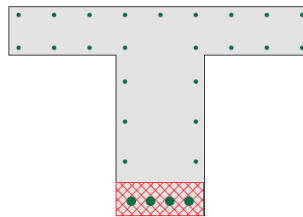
Zone entourant l'armature principale d'une section en T pouvant être considérée comme tirant [74]
